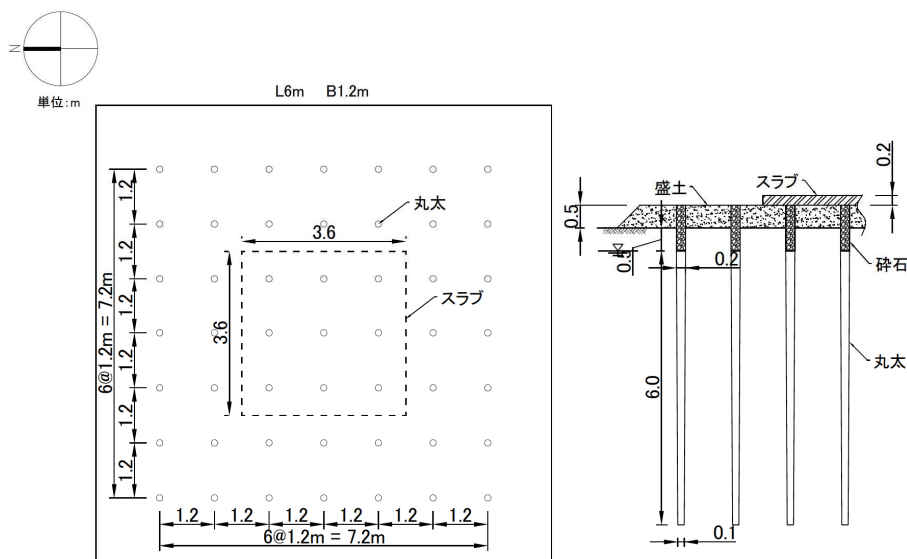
丸太とスラブの平面図と断面図の一例 (AO 地点 : L06B12)
